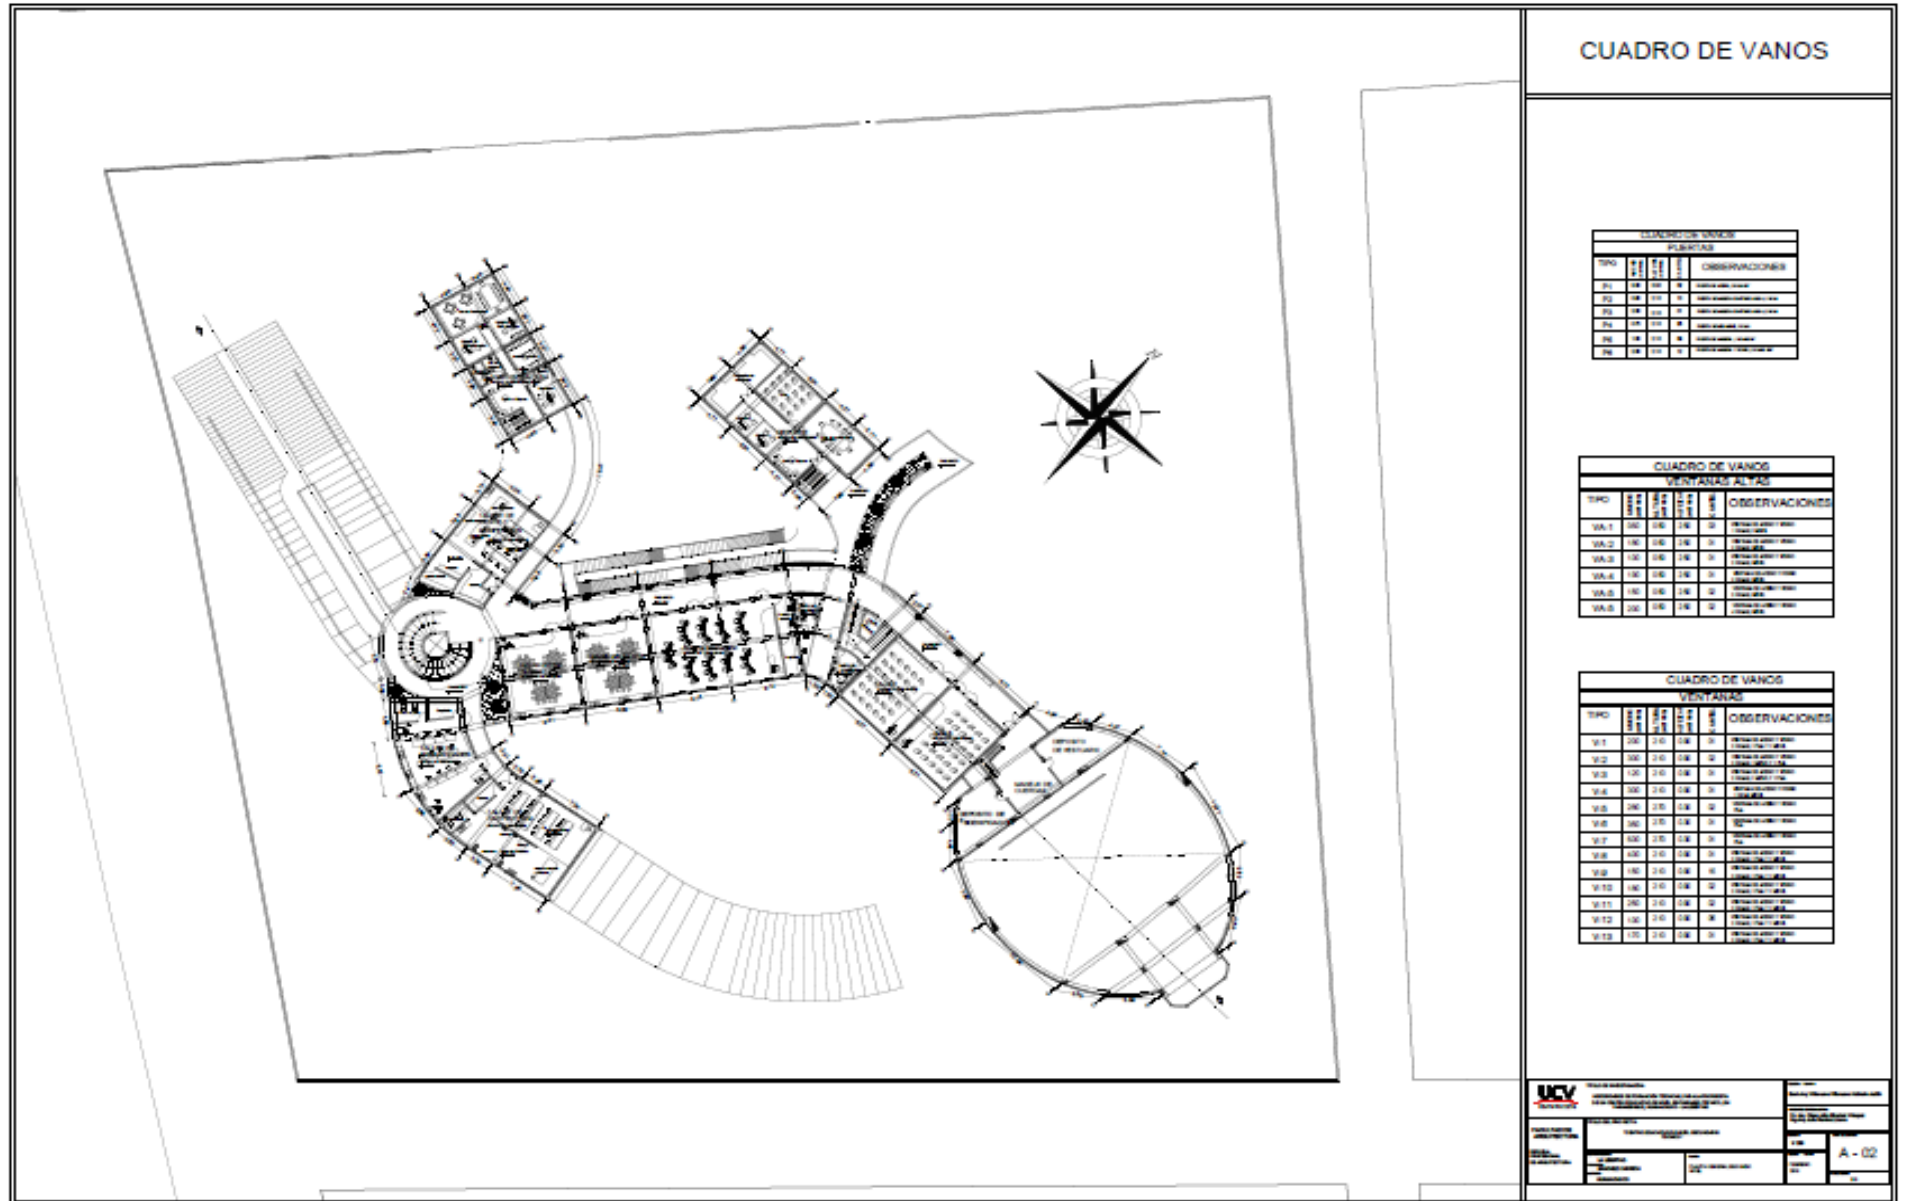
Plano de Distribución – Plano N° 06 - Lamina A-02
